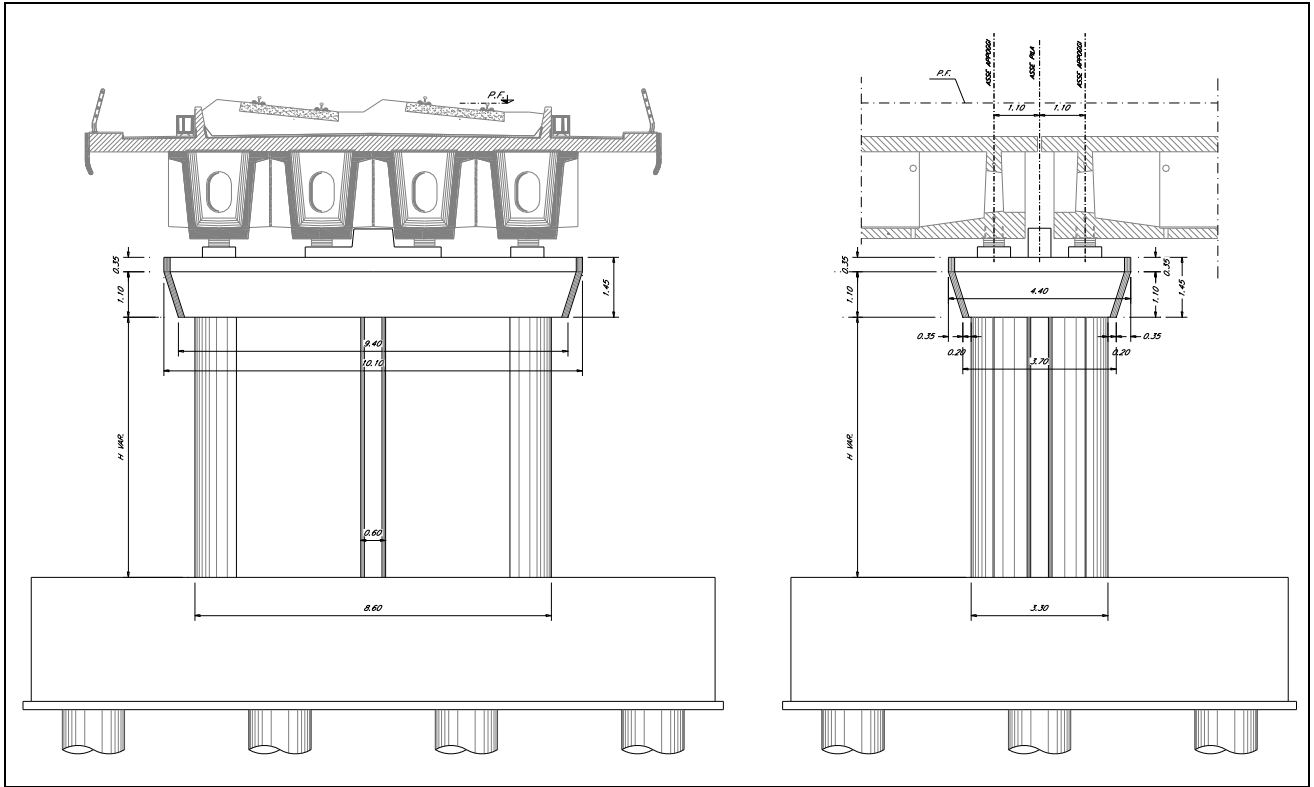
Viste pila tipologica per impalcato L=25.00m, sezione 3.30m x 8.60m
